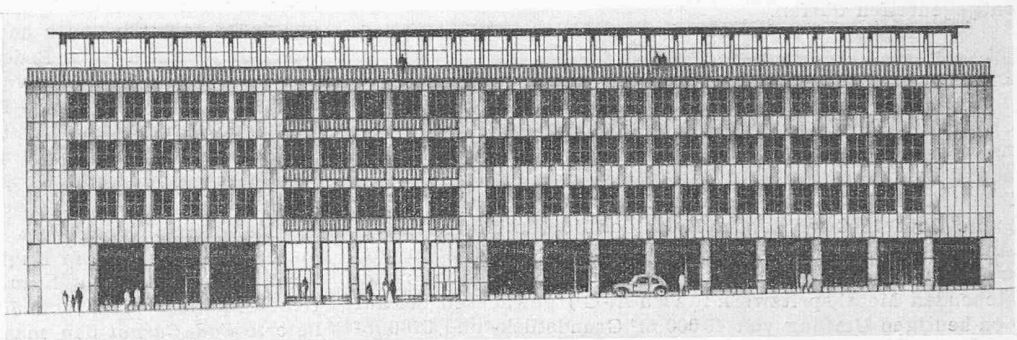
Wiederaufbauprojekt, Masstab rd. 1 : 550. Städt. Hochbauamt, Baurat Teichen
